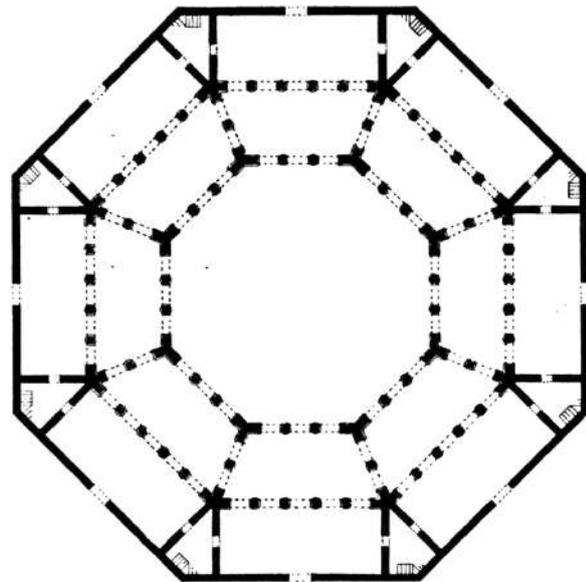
Hauptkirche von Antiochia, Rekonstruktion des Grundrisses, um 327
